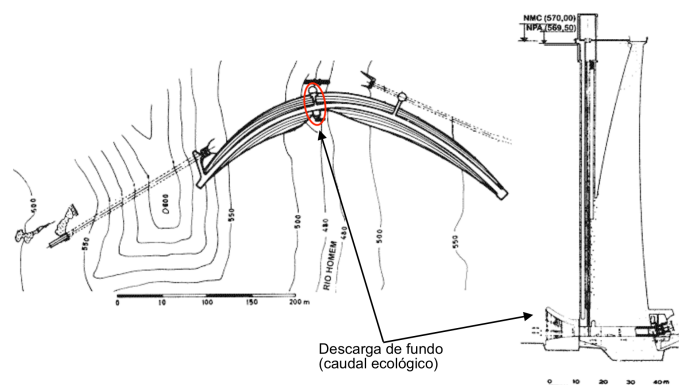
Barragem de Vilarinho das Furnas. Planta e perfil da barragem. Adaptado de (cnpqg.apambiente.pt).
